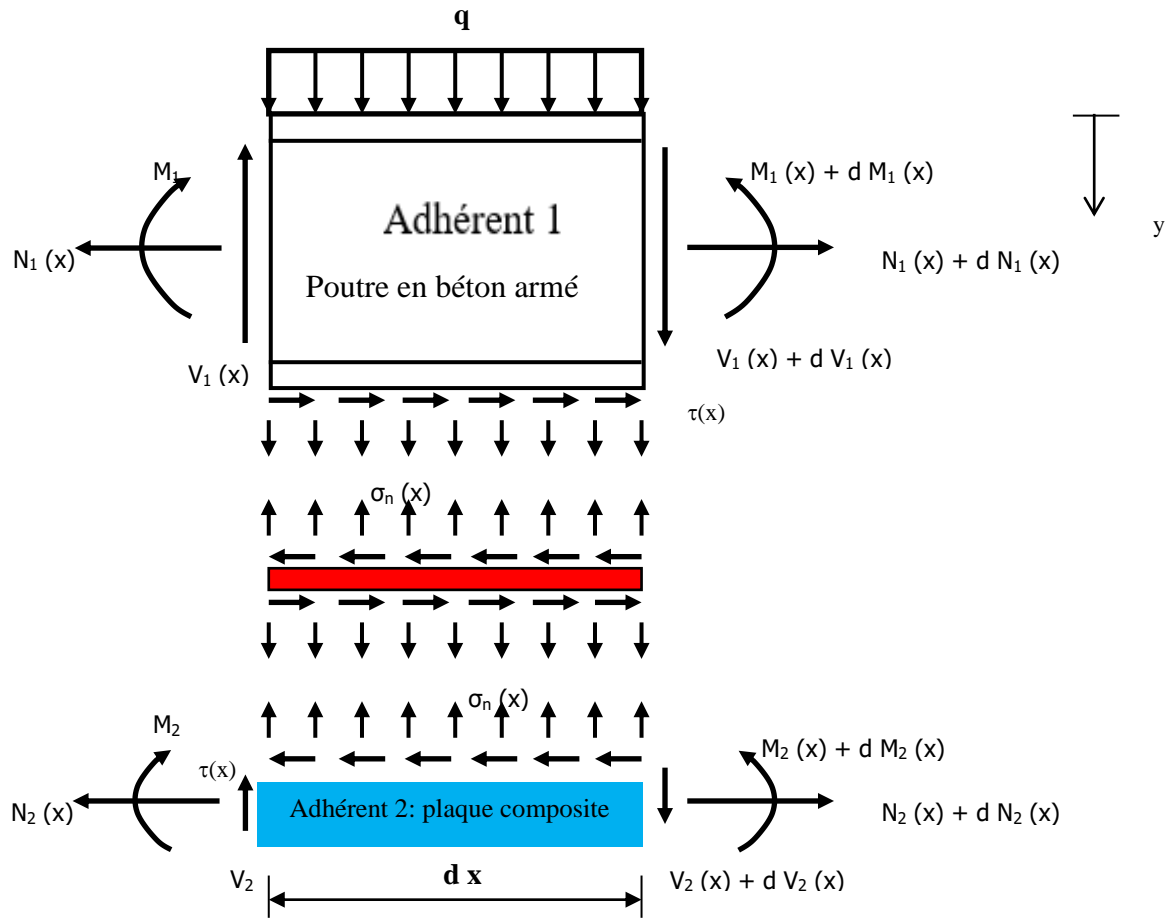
Un segment différentiel de la poutre en béton renforcée par collage de composite
